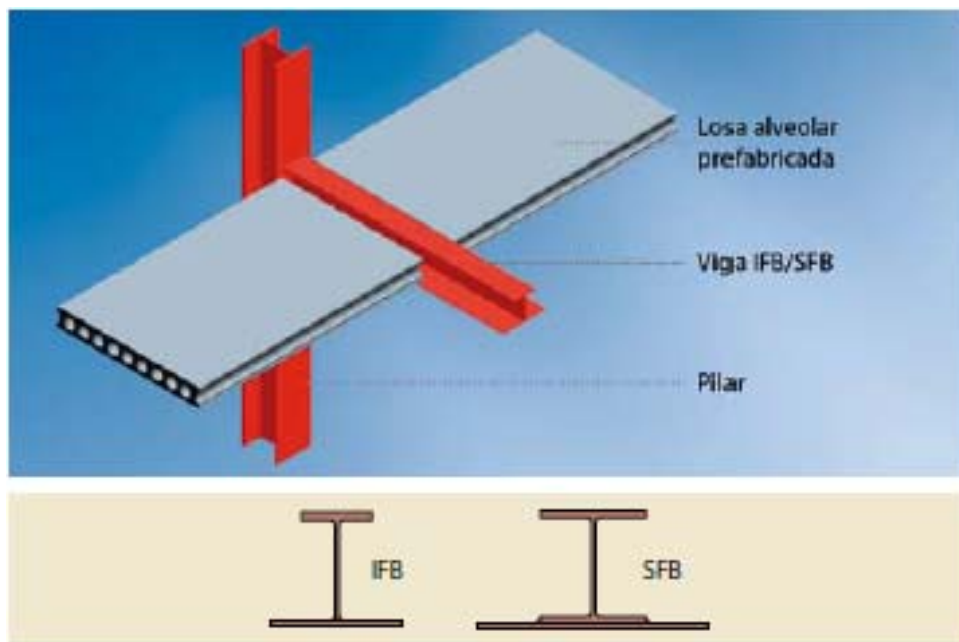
Forjado integrado con vigas asimétricas y placas de hormigón prefabricado
